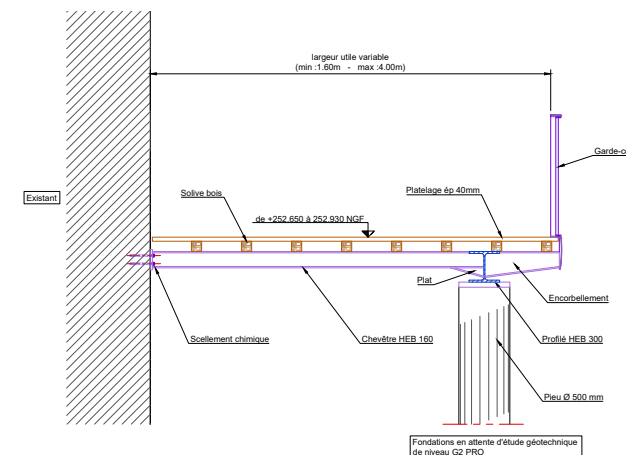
Coupe descriptive du franchissement du pont de Belleville (source : ARTELIA, janvier 2018).
